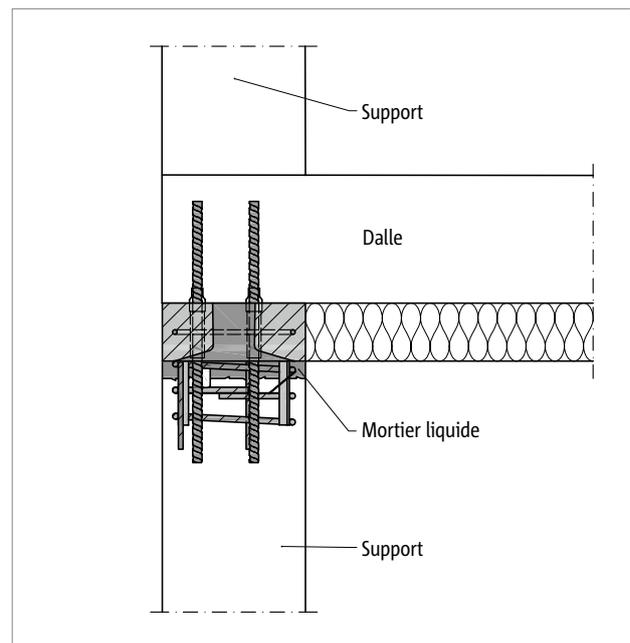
Schöck Sconnex® type P : raccordement d'un poteau de bord à la dalle sus-jacente
